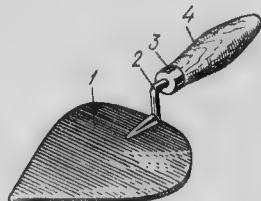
1 — полотно; 2 — колесо; 3 — колпачок; 4 — ручка
